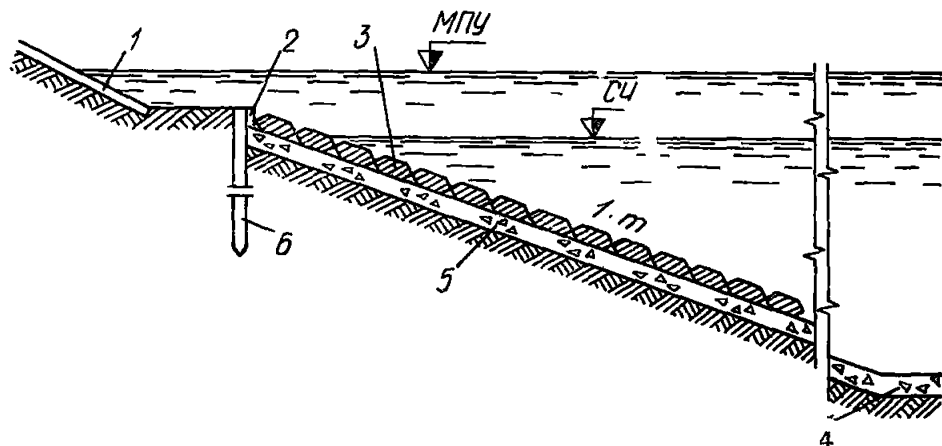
Откосные покрытия плитами из монолитного железобетона
